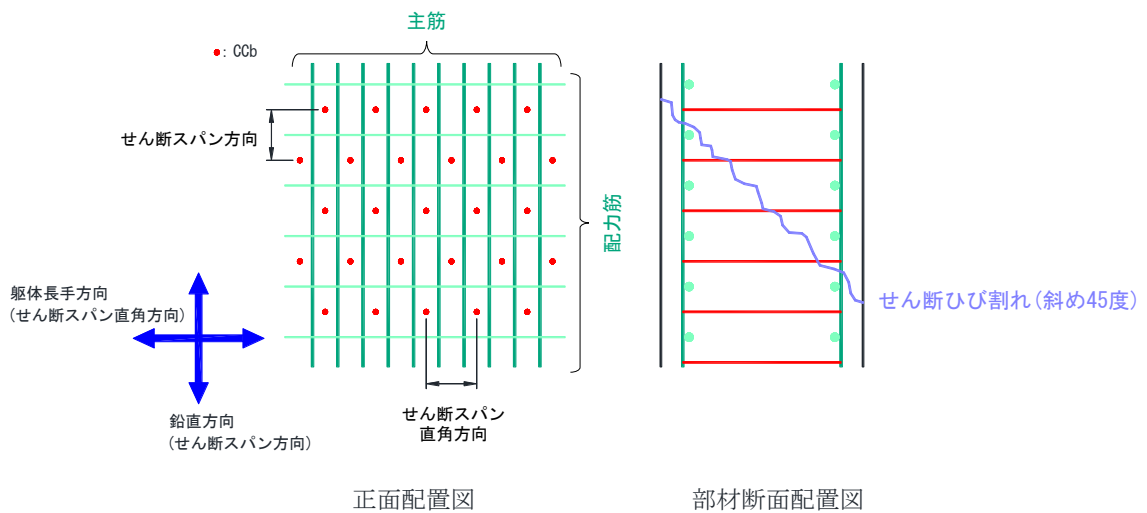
せん断補強筋正面配置図及び部材断面配置図
